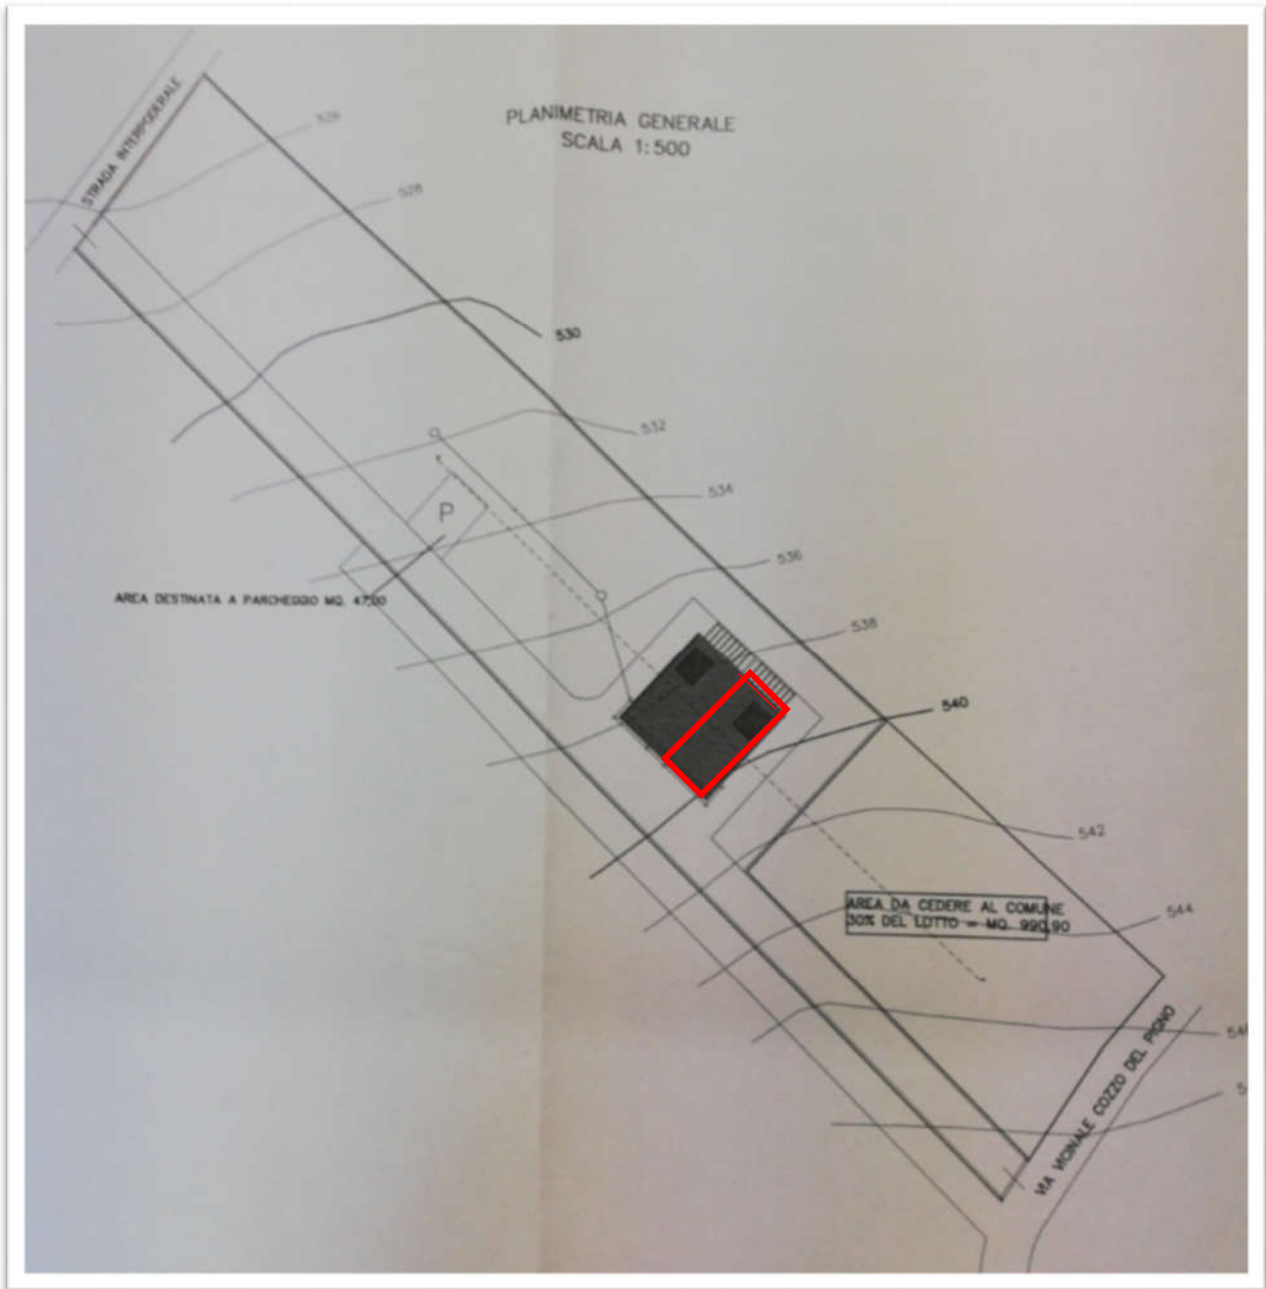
Planimetria del lotto (p.la 2301) con indicazione in rosso dell'immobile pignorato
